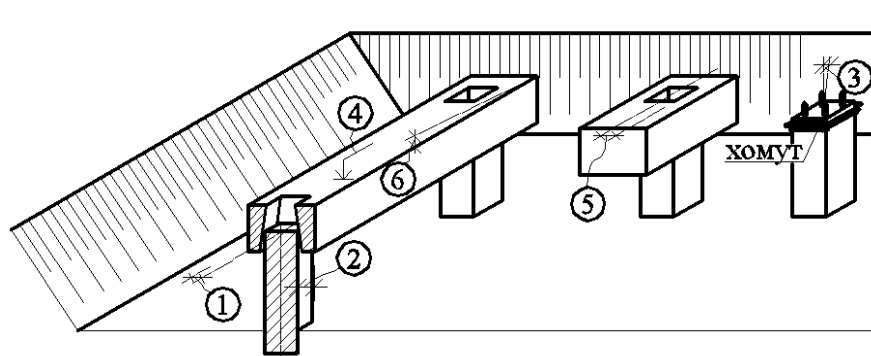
Монтаж сборных оголовков безростверкового фундамента
